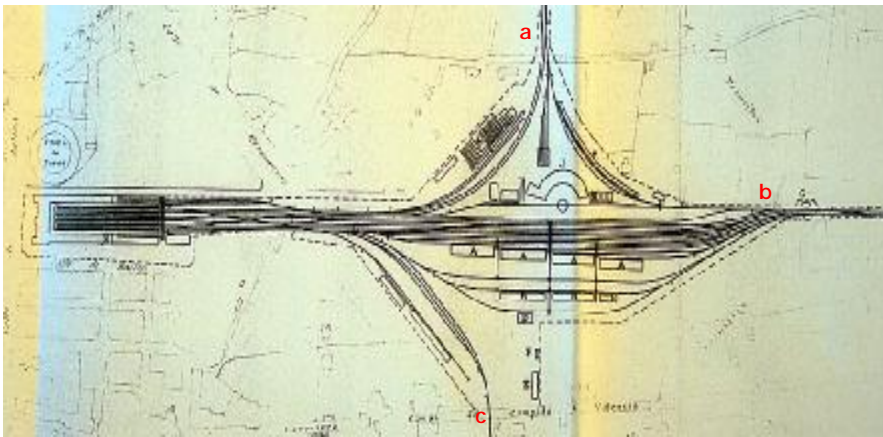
Plano de emplazamiento general de la estación. Ing. Grasset. (AGA)- 2008).
